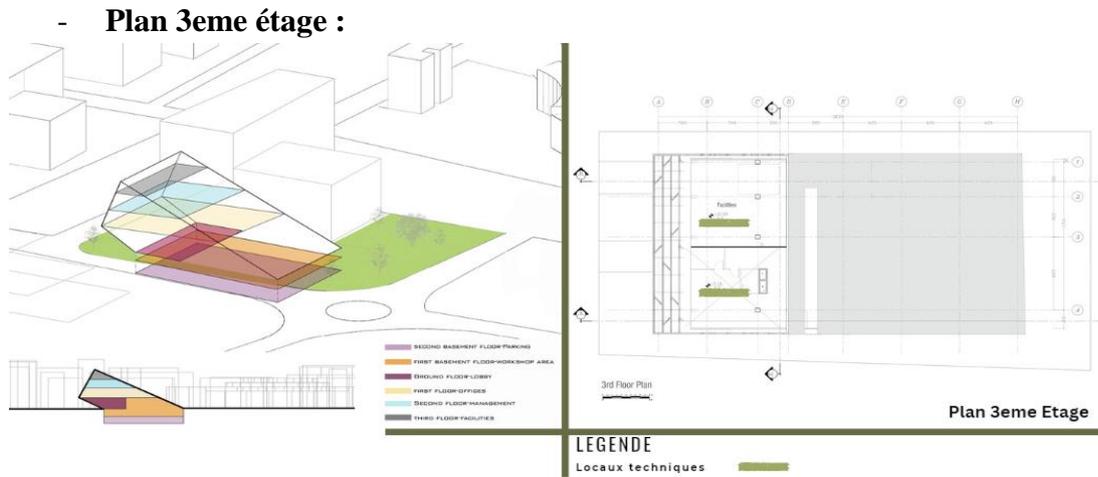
Plan 3eme étage et fonctionnement des autres étage, source: archdaily et auteur
